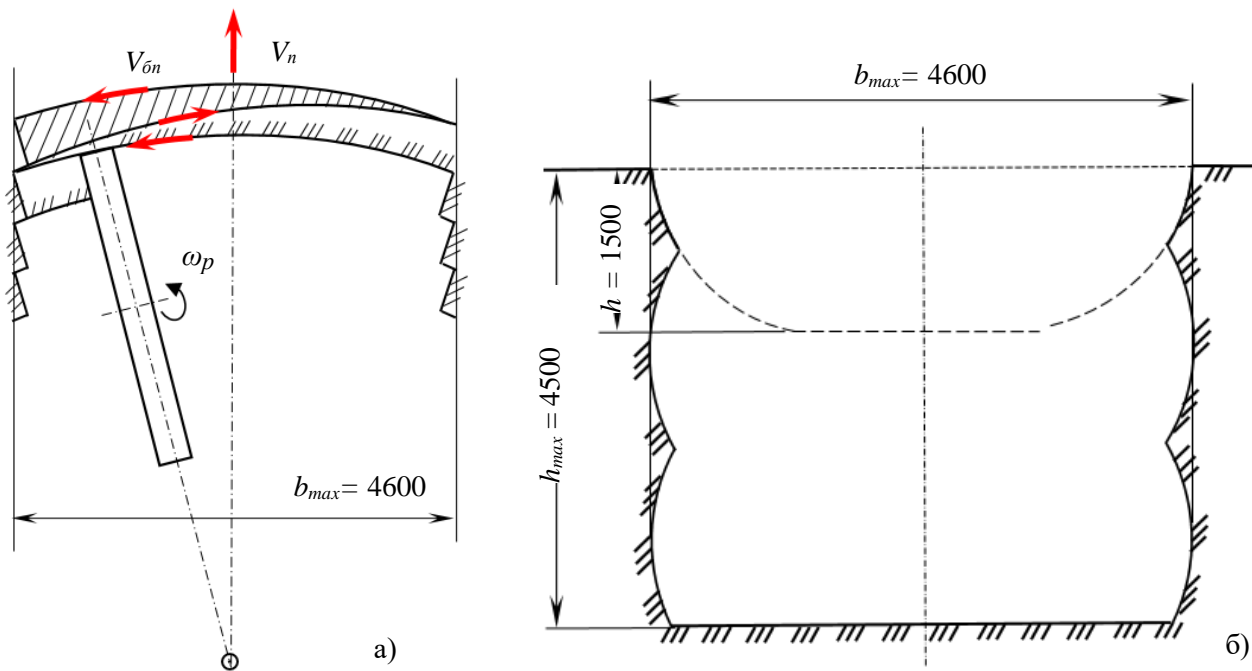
Схема відривання котловану: а) – вид в плані; б) – поперечний переріз виїмки
